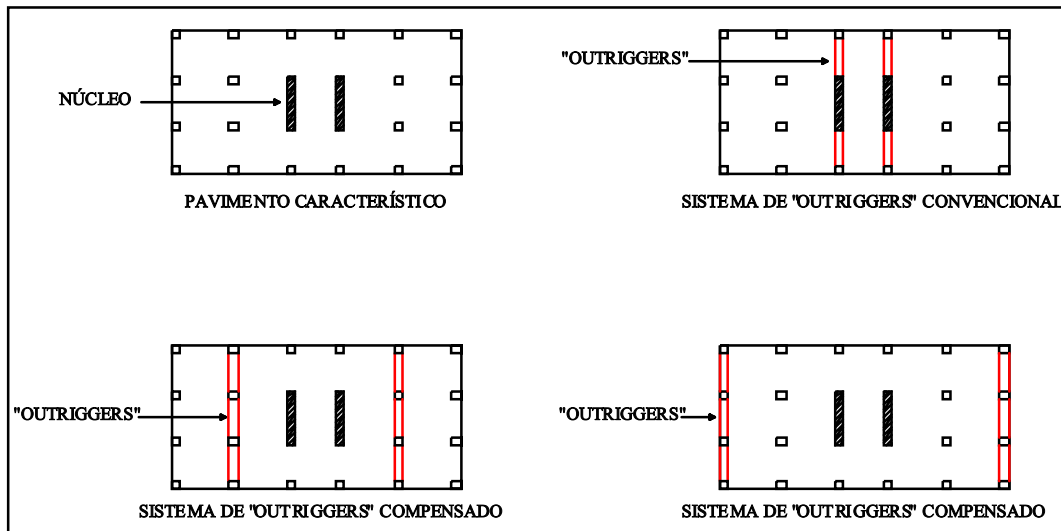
Sistema de “outriggers” convencional e compensado
